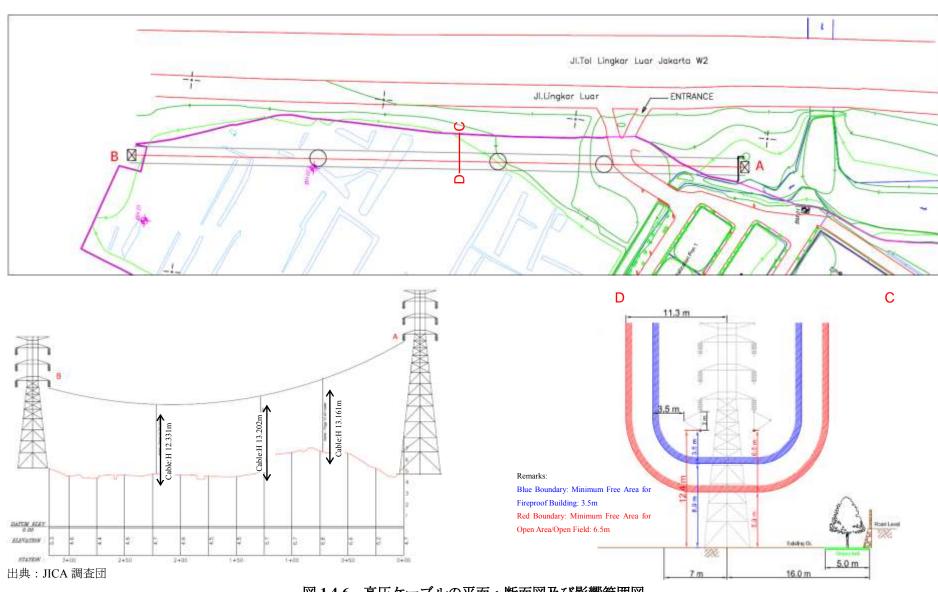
高圧ケーブルの平面・断面図及び影響範囲図
